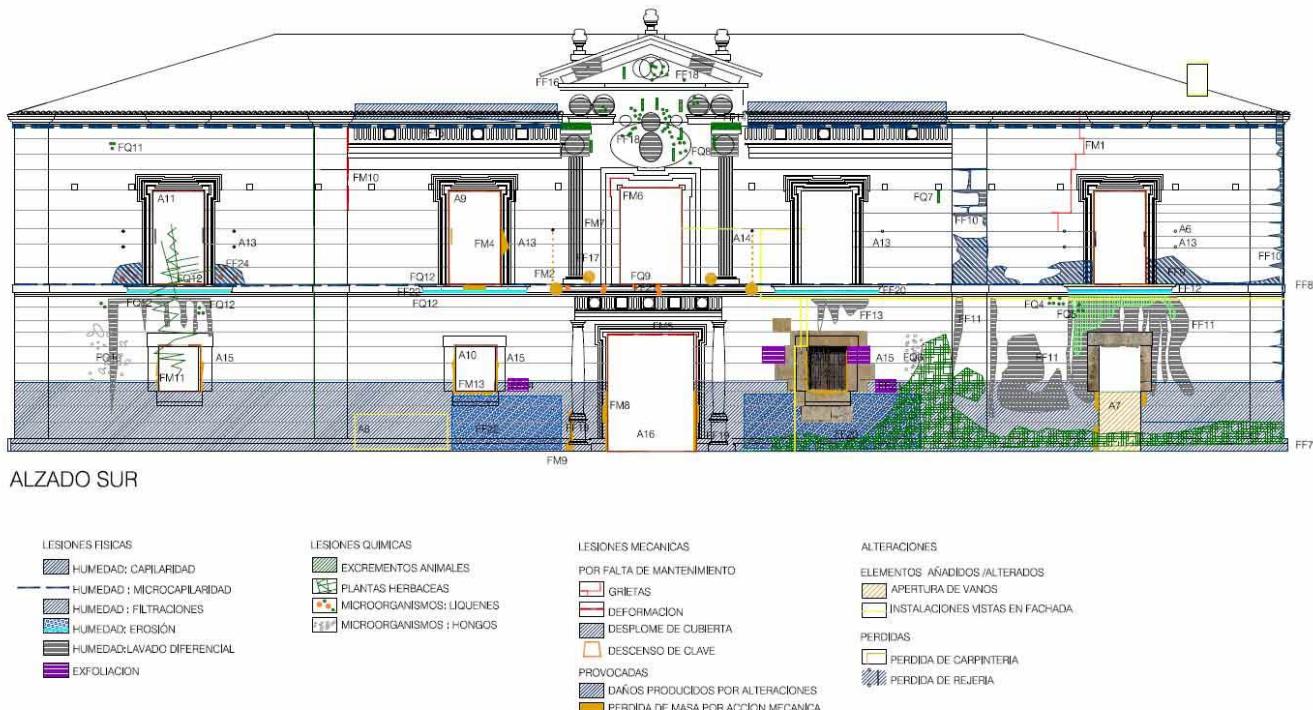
Lesiones identificadas en el alzado Sur. Damage identified on the south façade.
